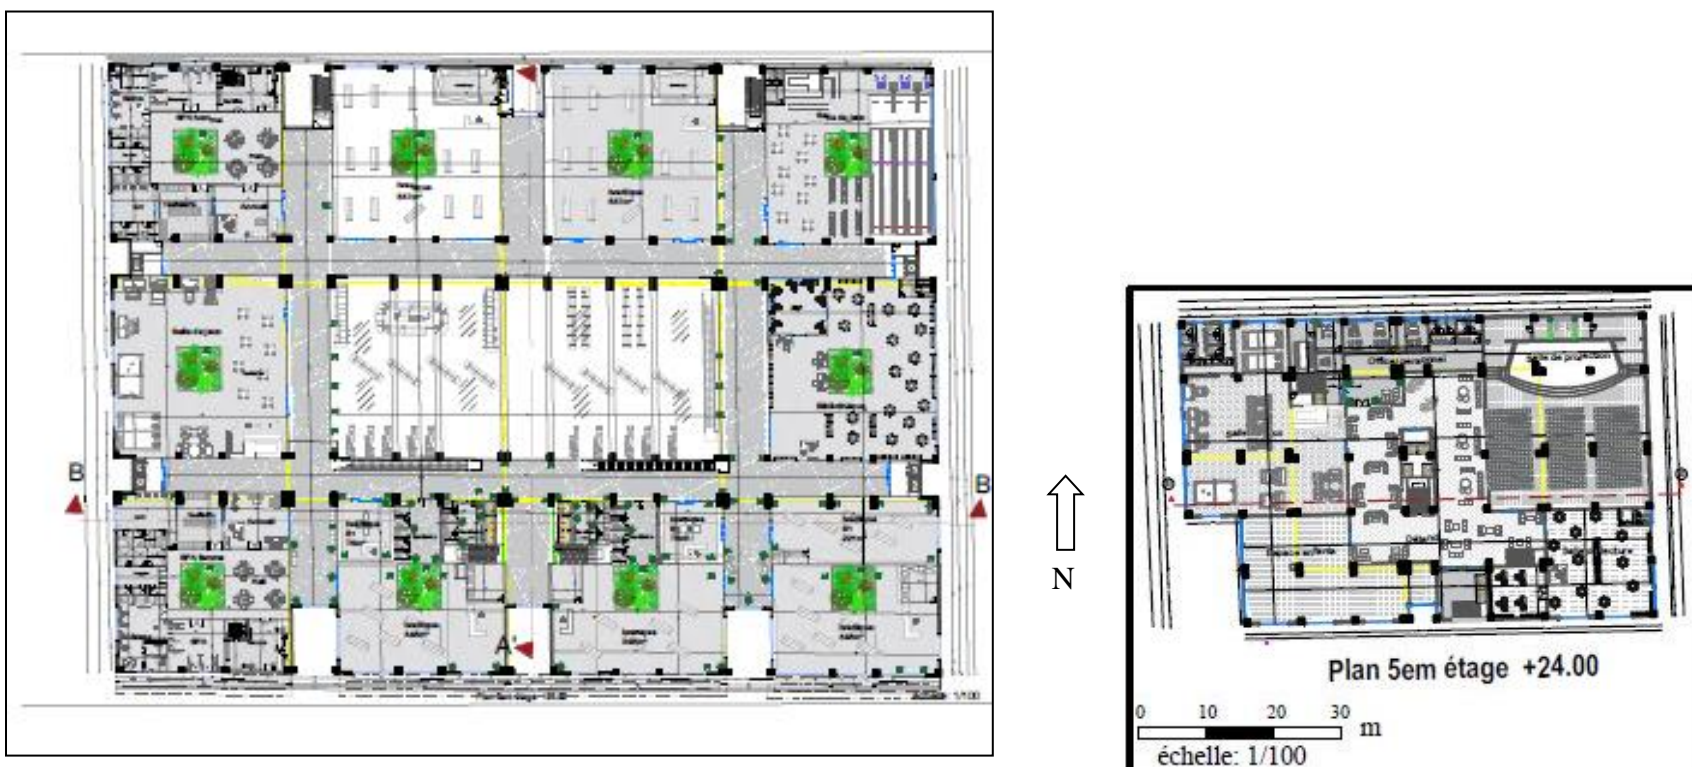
Plan de 5eme étage+24.00/Source : Traiter par l'auteur.
